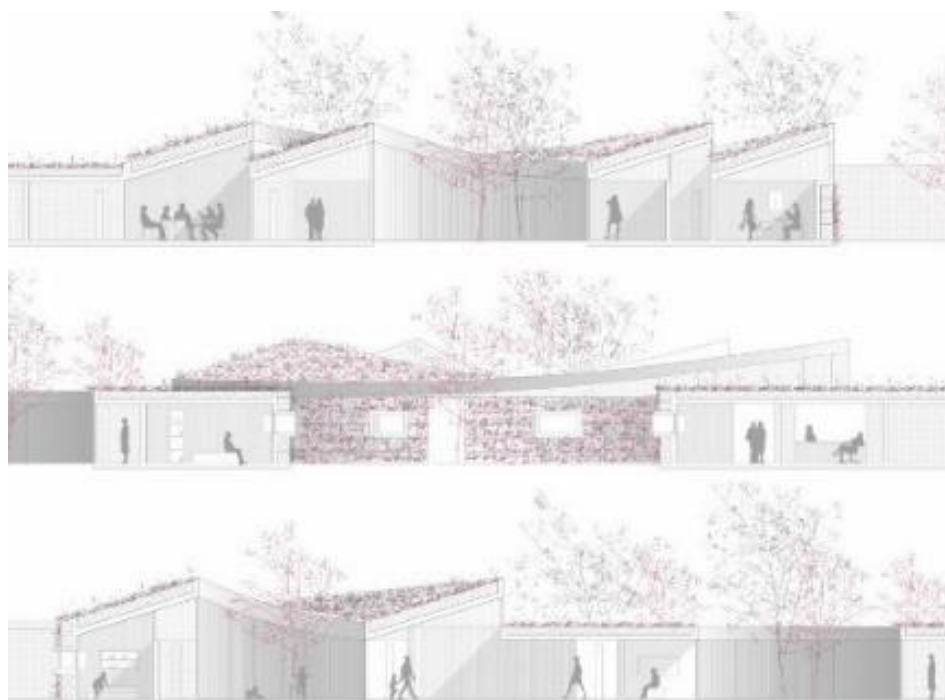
Sezioni dei diversi moduli con tetti e facciate verdi (fonte: OOIO Architecture)
